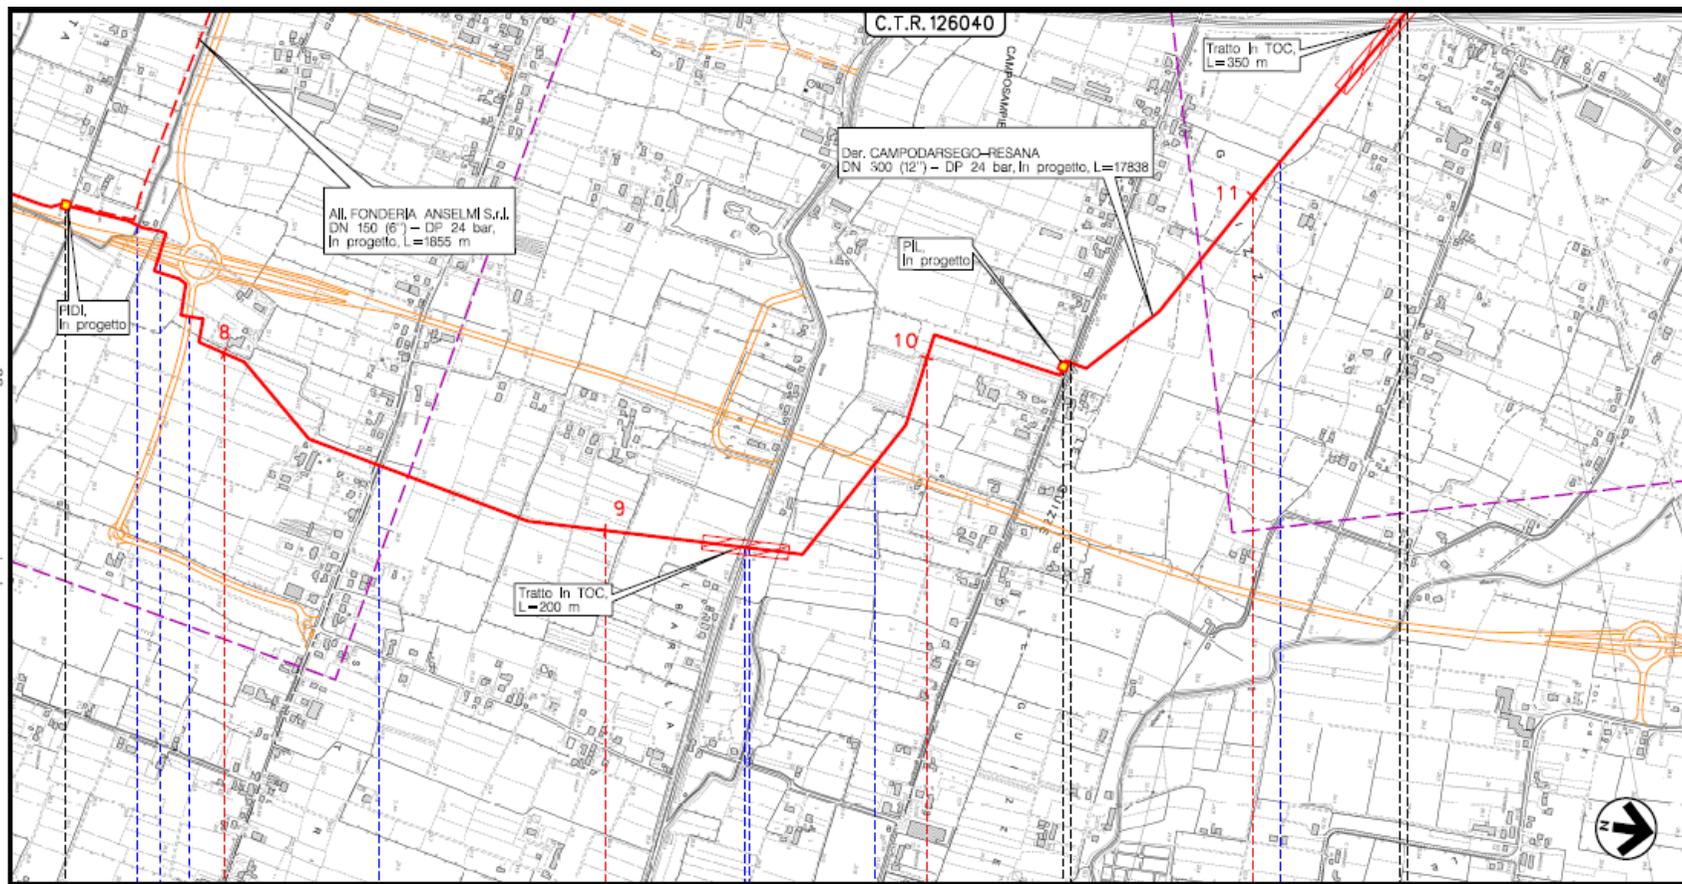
1^a TRATTO - Stralcio planimetria CTR con localizzazione dell'area di intervento
